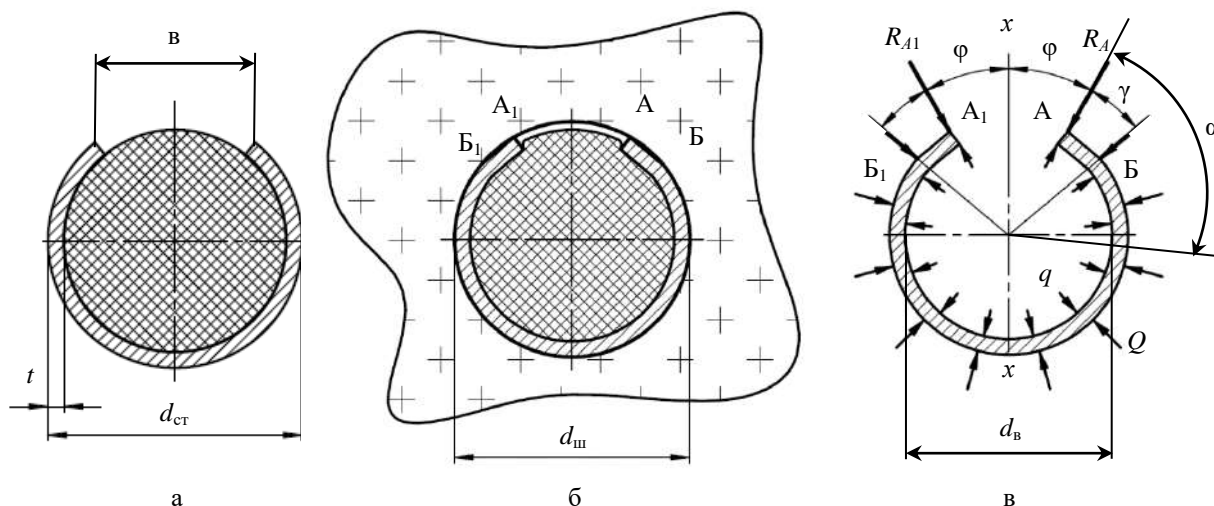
Поперечное сечение, выполненное в передней части стержня: а – сечение стержня анкера до установки в шпур; б – сечение после установки в шпур; в – схема нагружения стержня анкера
